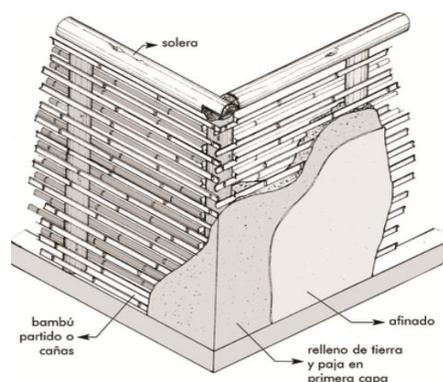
Detalle de la estructura de muro en bahareque (Rivera, 2018)
